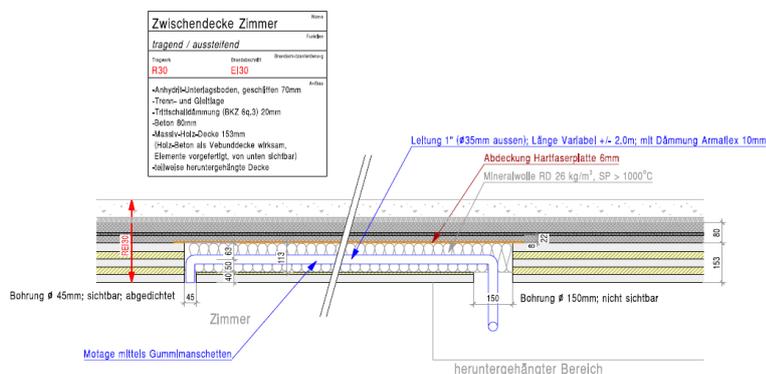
Einlegen der Sprinklerleitungen in ein Holz-Beton-Verbund-Element (Foto Balteschwiler Laufenburg; Detail Makiol Wiederkehr AG)
